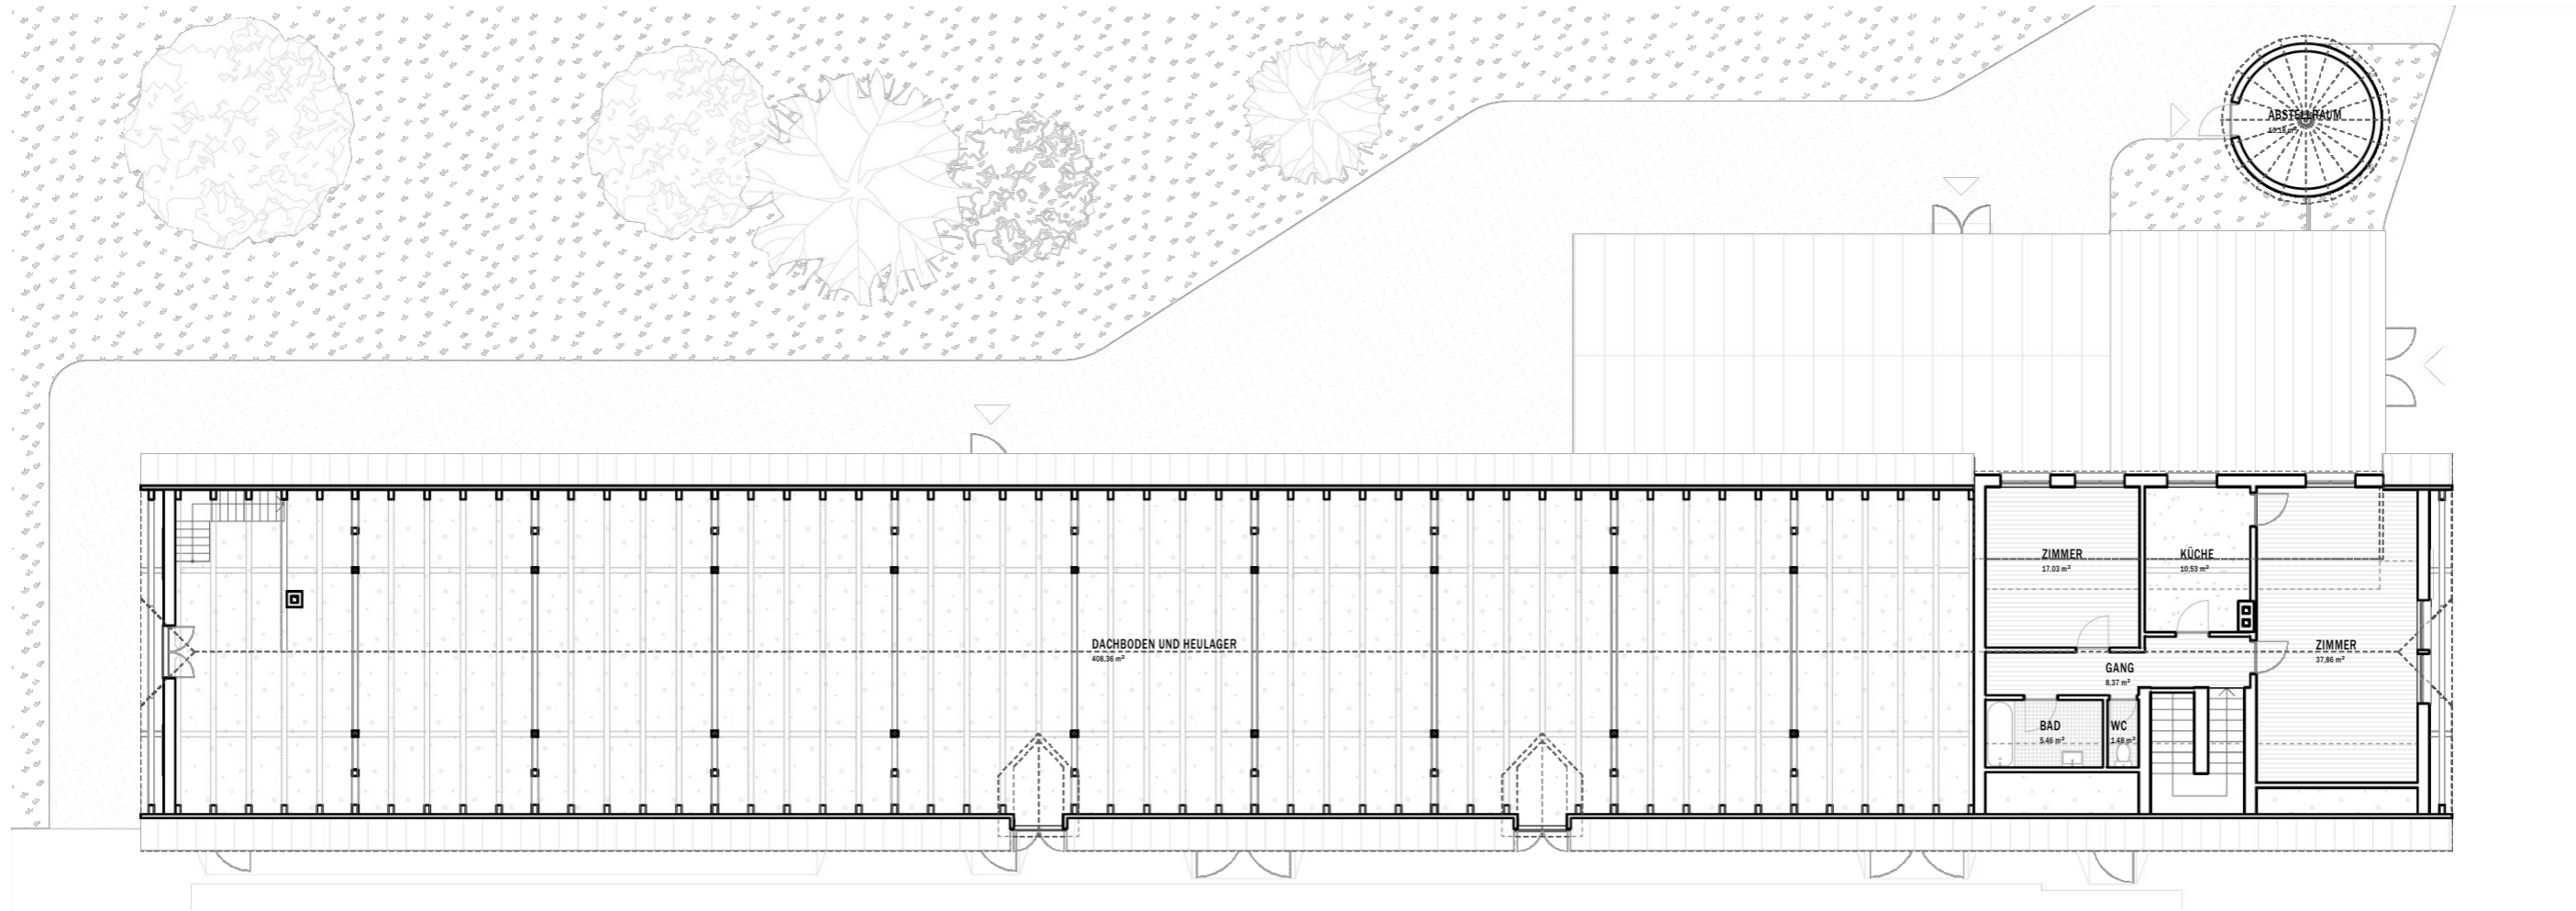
Grundriss OG, Stallgebäude
